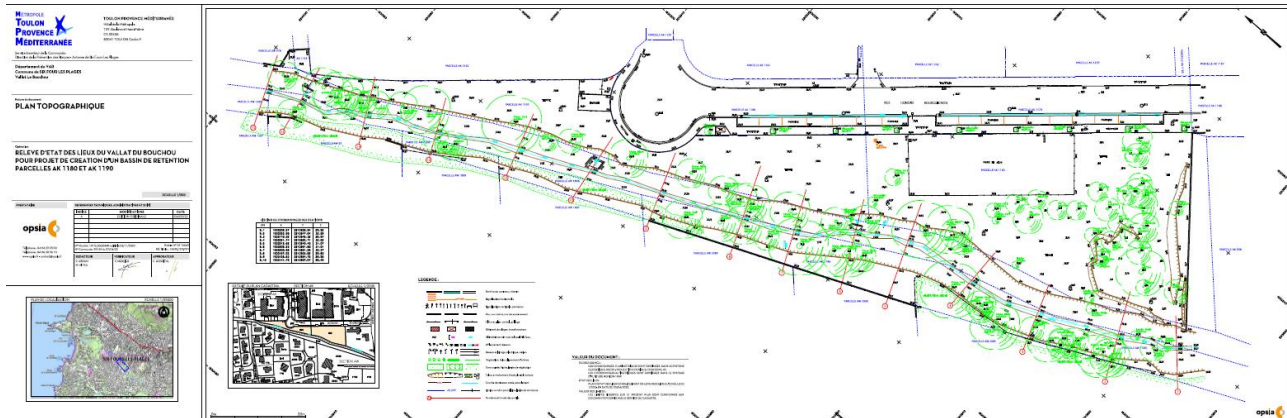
PLAN TOPOGRAPHIQUE DU BASSIN DE RETENTION DE BARRAS
